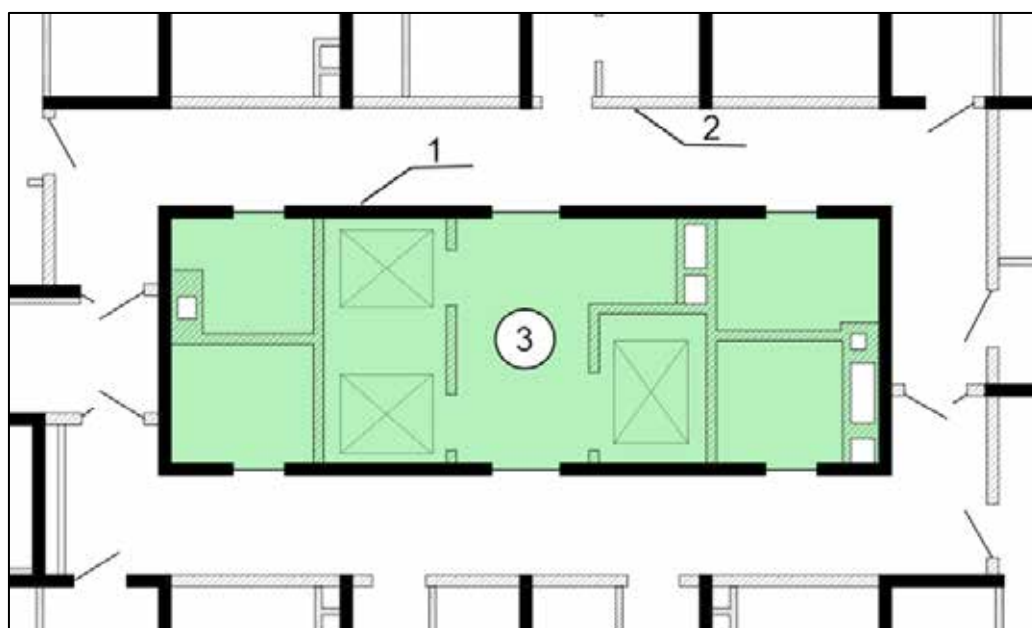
Фрагмент плану монолітно-каркасного будинку: 1 – монолітні бетонні елементи каркаса; 2 – заповнення легкобетонними блоками; 3 – безпечний простір
